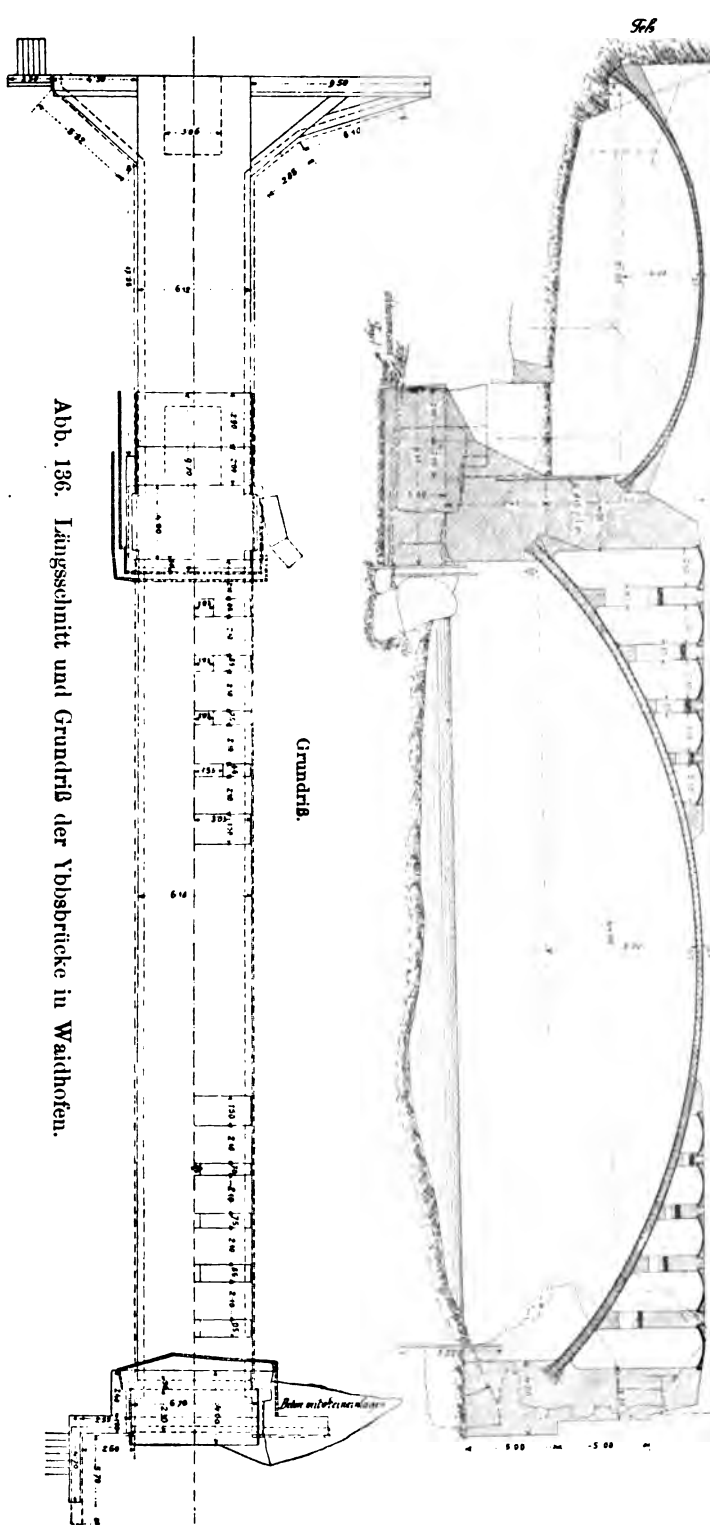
Längsschnitt und Grundriß der Ybsbrücke in Waldfrieden.
